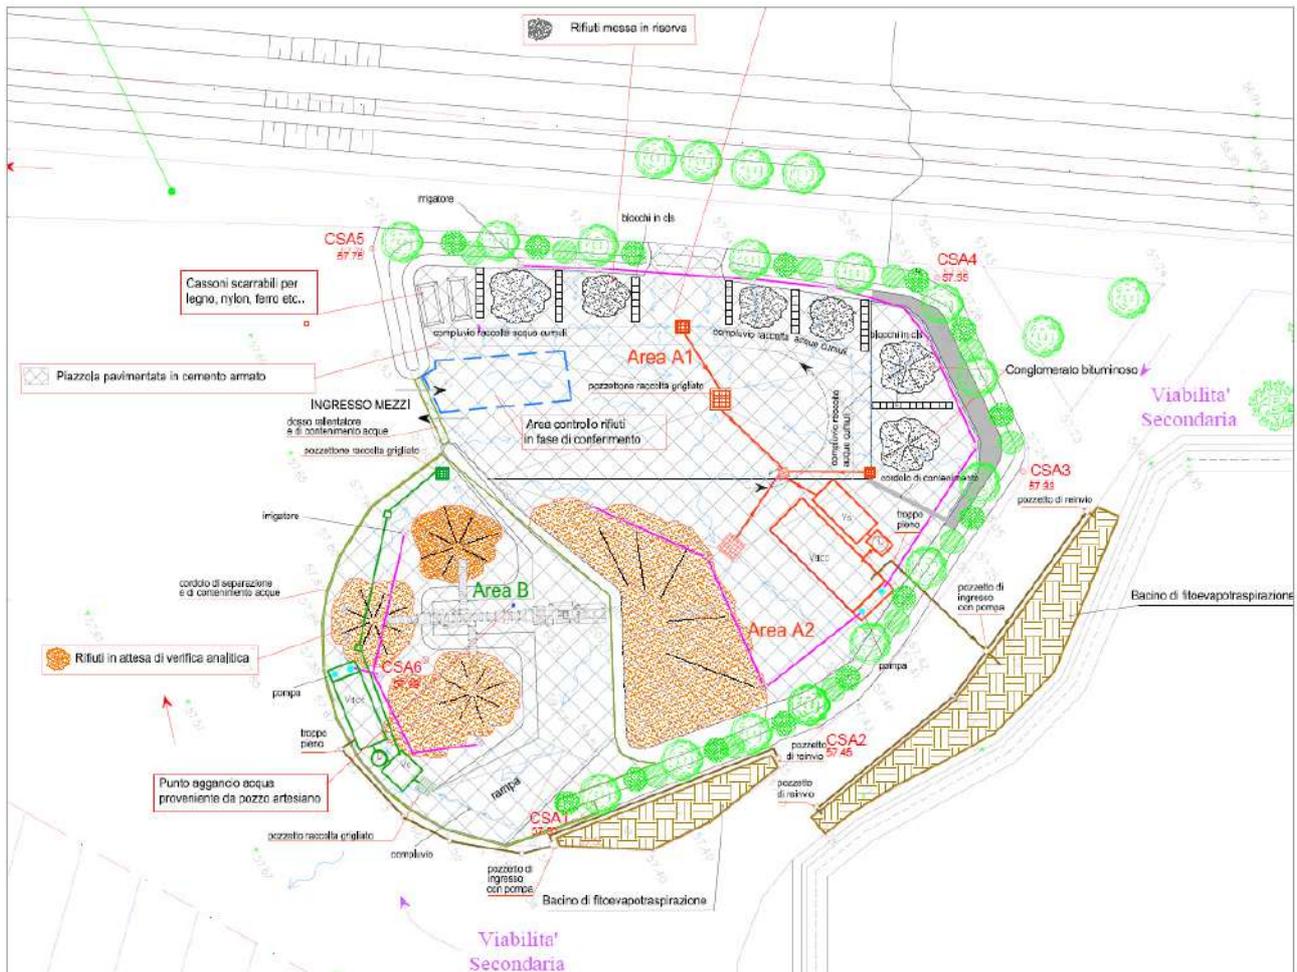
area di cantiere Superbeton – Santa Lucia di Piave
